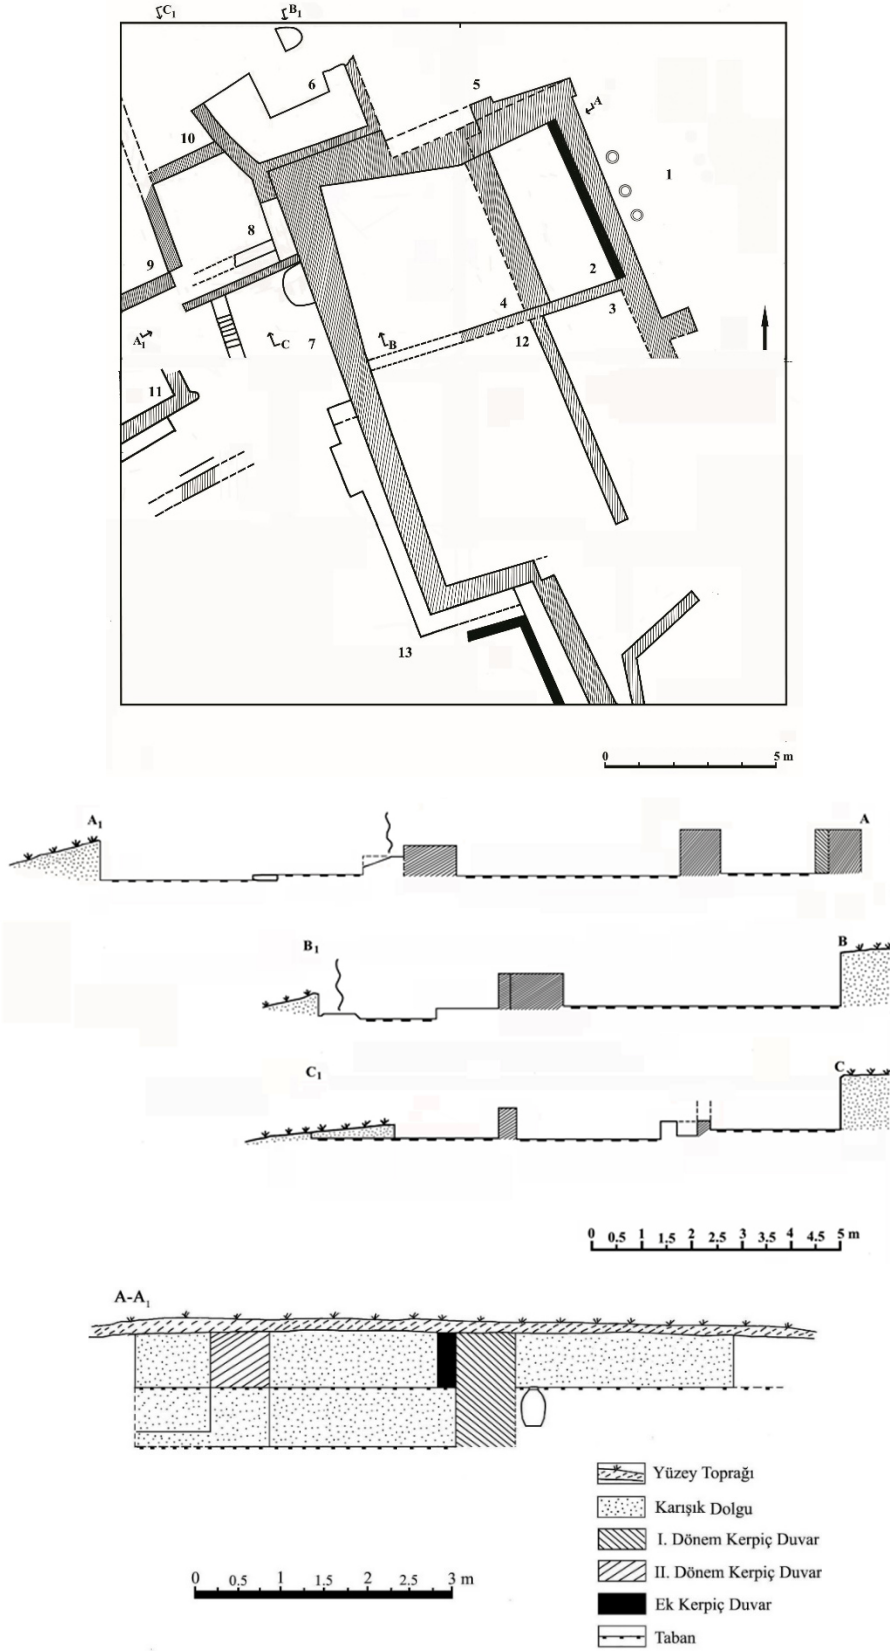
Yalpak Tepe Sarayı planı ve kesitleri
